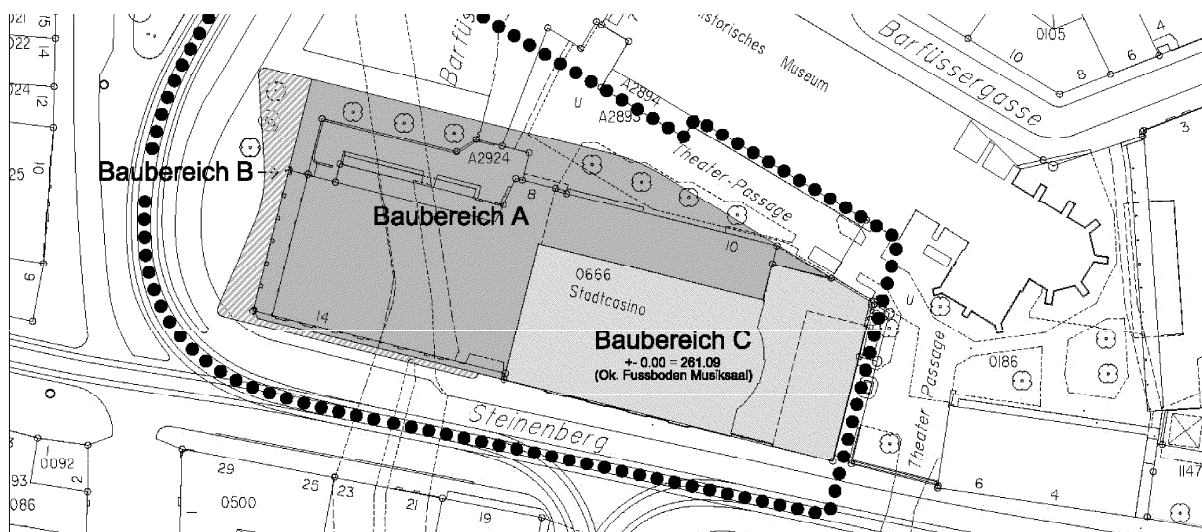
Plan Nr. 13'175. Bebauungsplan: Situation. (kein Massstab, Plan genordet)
